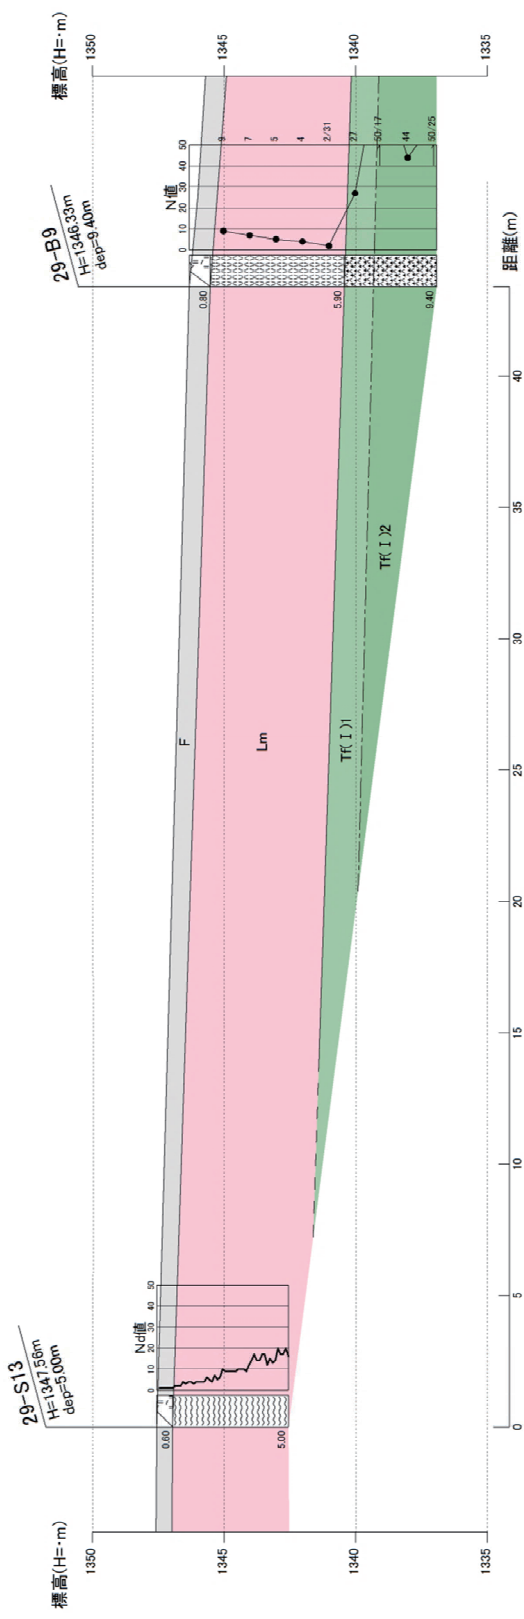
(1) 推定地質断面図 (変電施設部) 調査位置平面図
